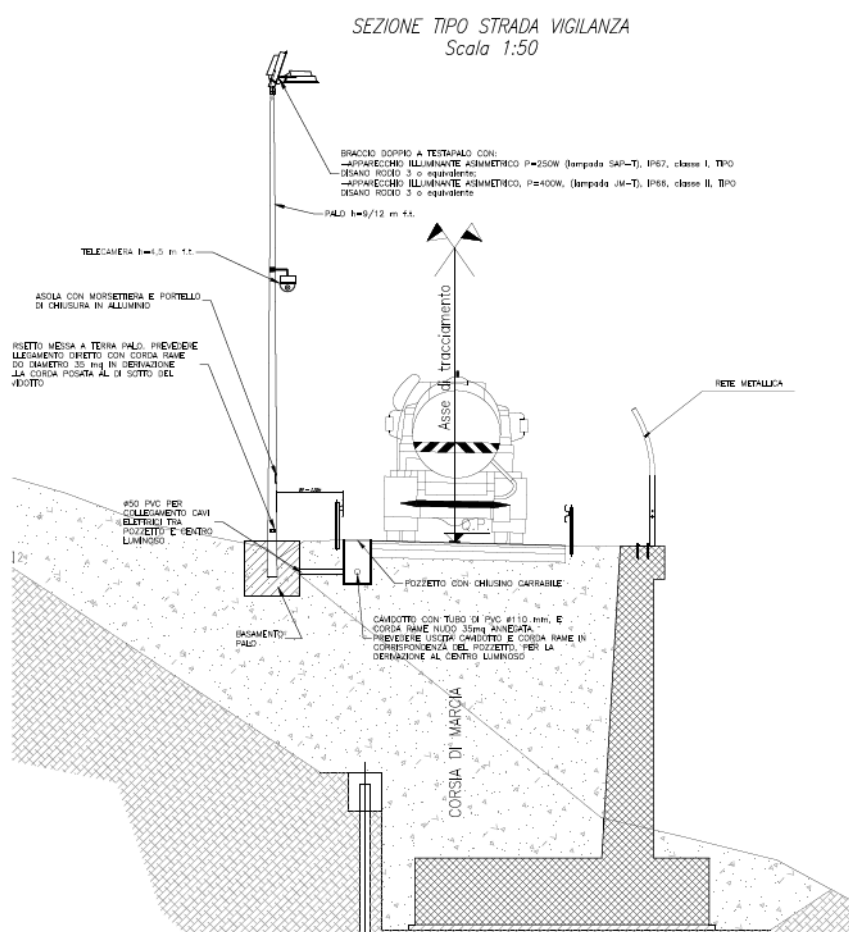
Sezione tipologica strade di vigilanza – impianto TVCC e Illuminazione
